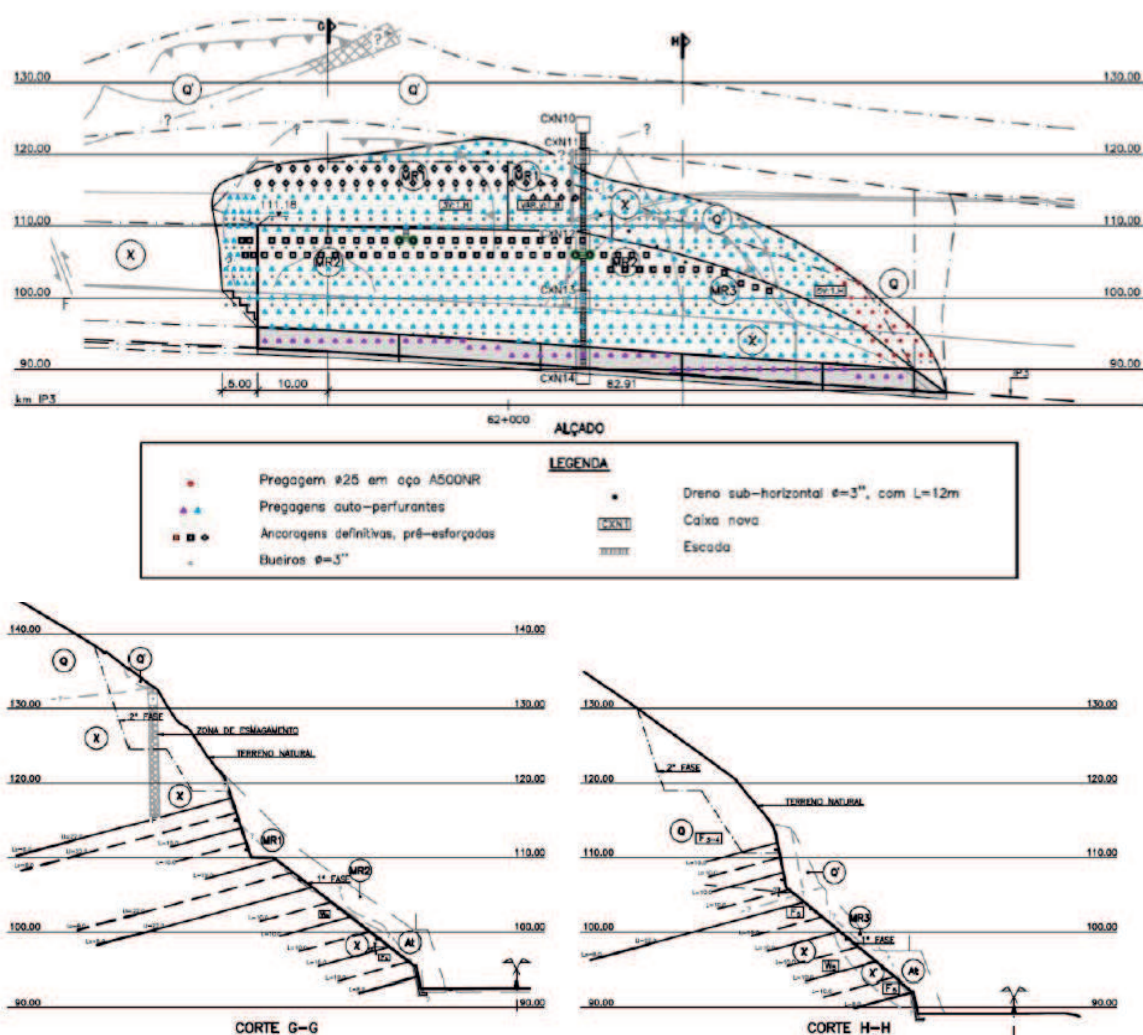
Alçado e cortes de uma das zonas a intervir - Zona B(Cenor).
